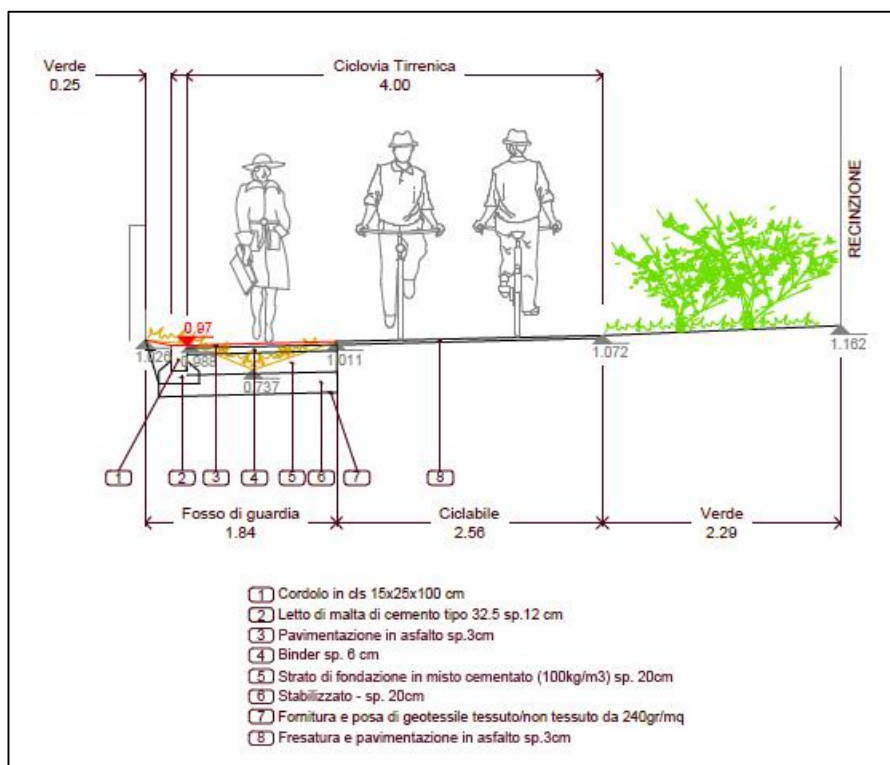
Sezione 16 di progetto trasversale SP delle Collacchie
